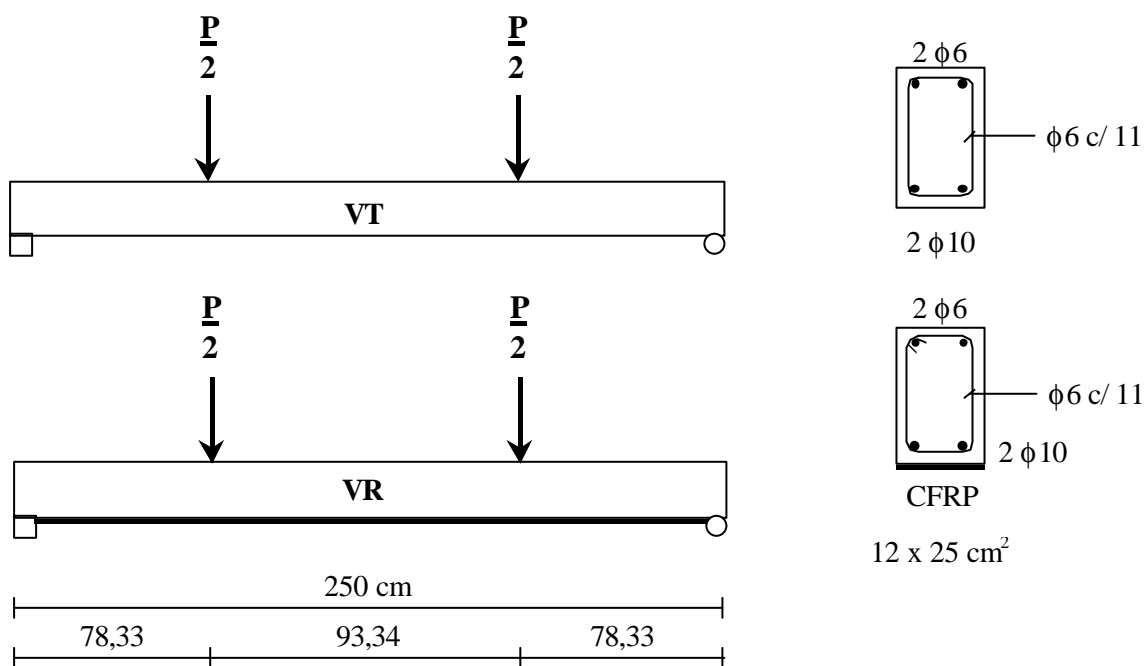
Geometria e carregamento das vigas VT e VR
